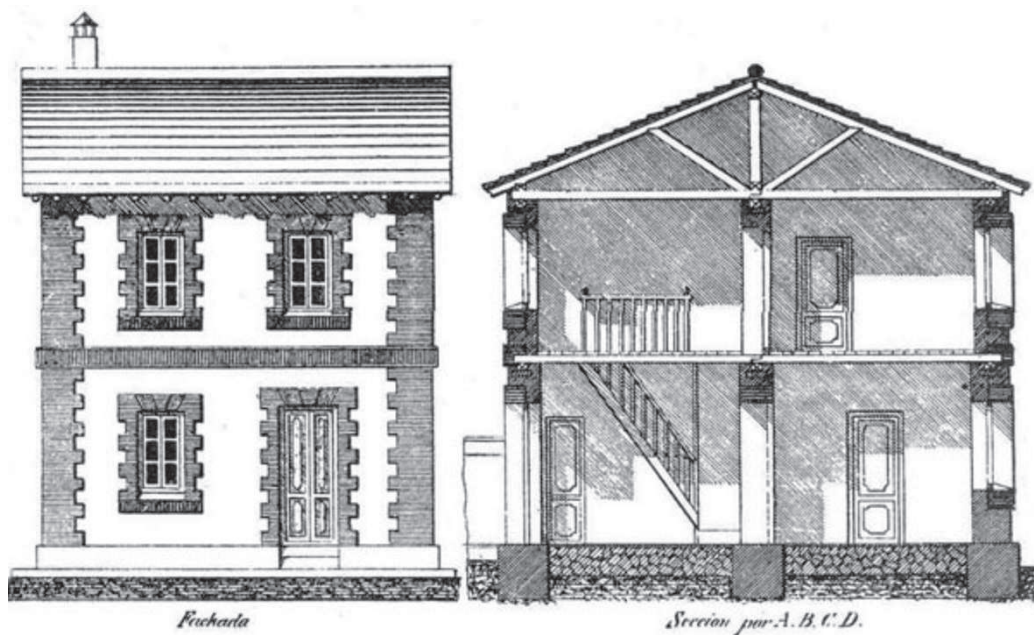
Detalles de Casa tipo 1 usada por la Comisaría Regia en la reconstrucción de los pueblos con más daños.
